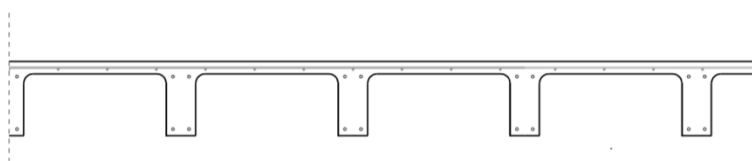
Detalle de composición de forjado unidireccional de viguetas. [2]
